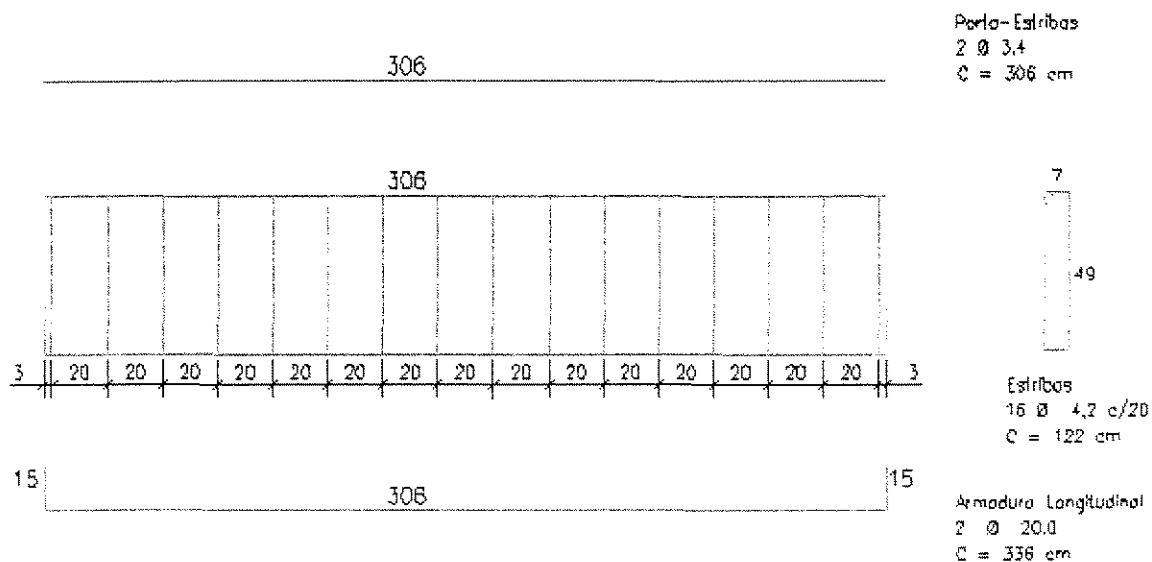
DETALHE DE ARMADURAS - VIGA 3BL-FLEX
